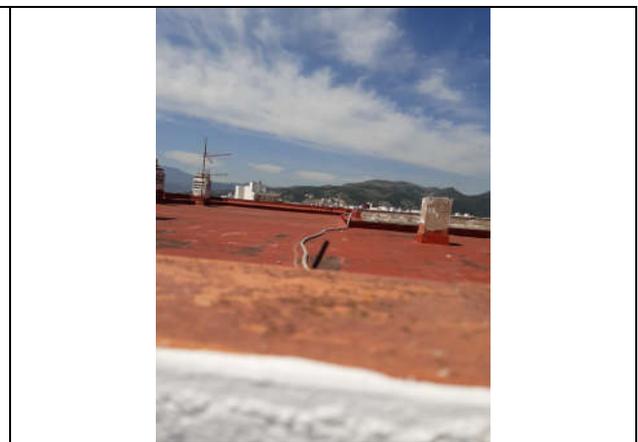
A: Fisuras en encuentros elementos constructivos
